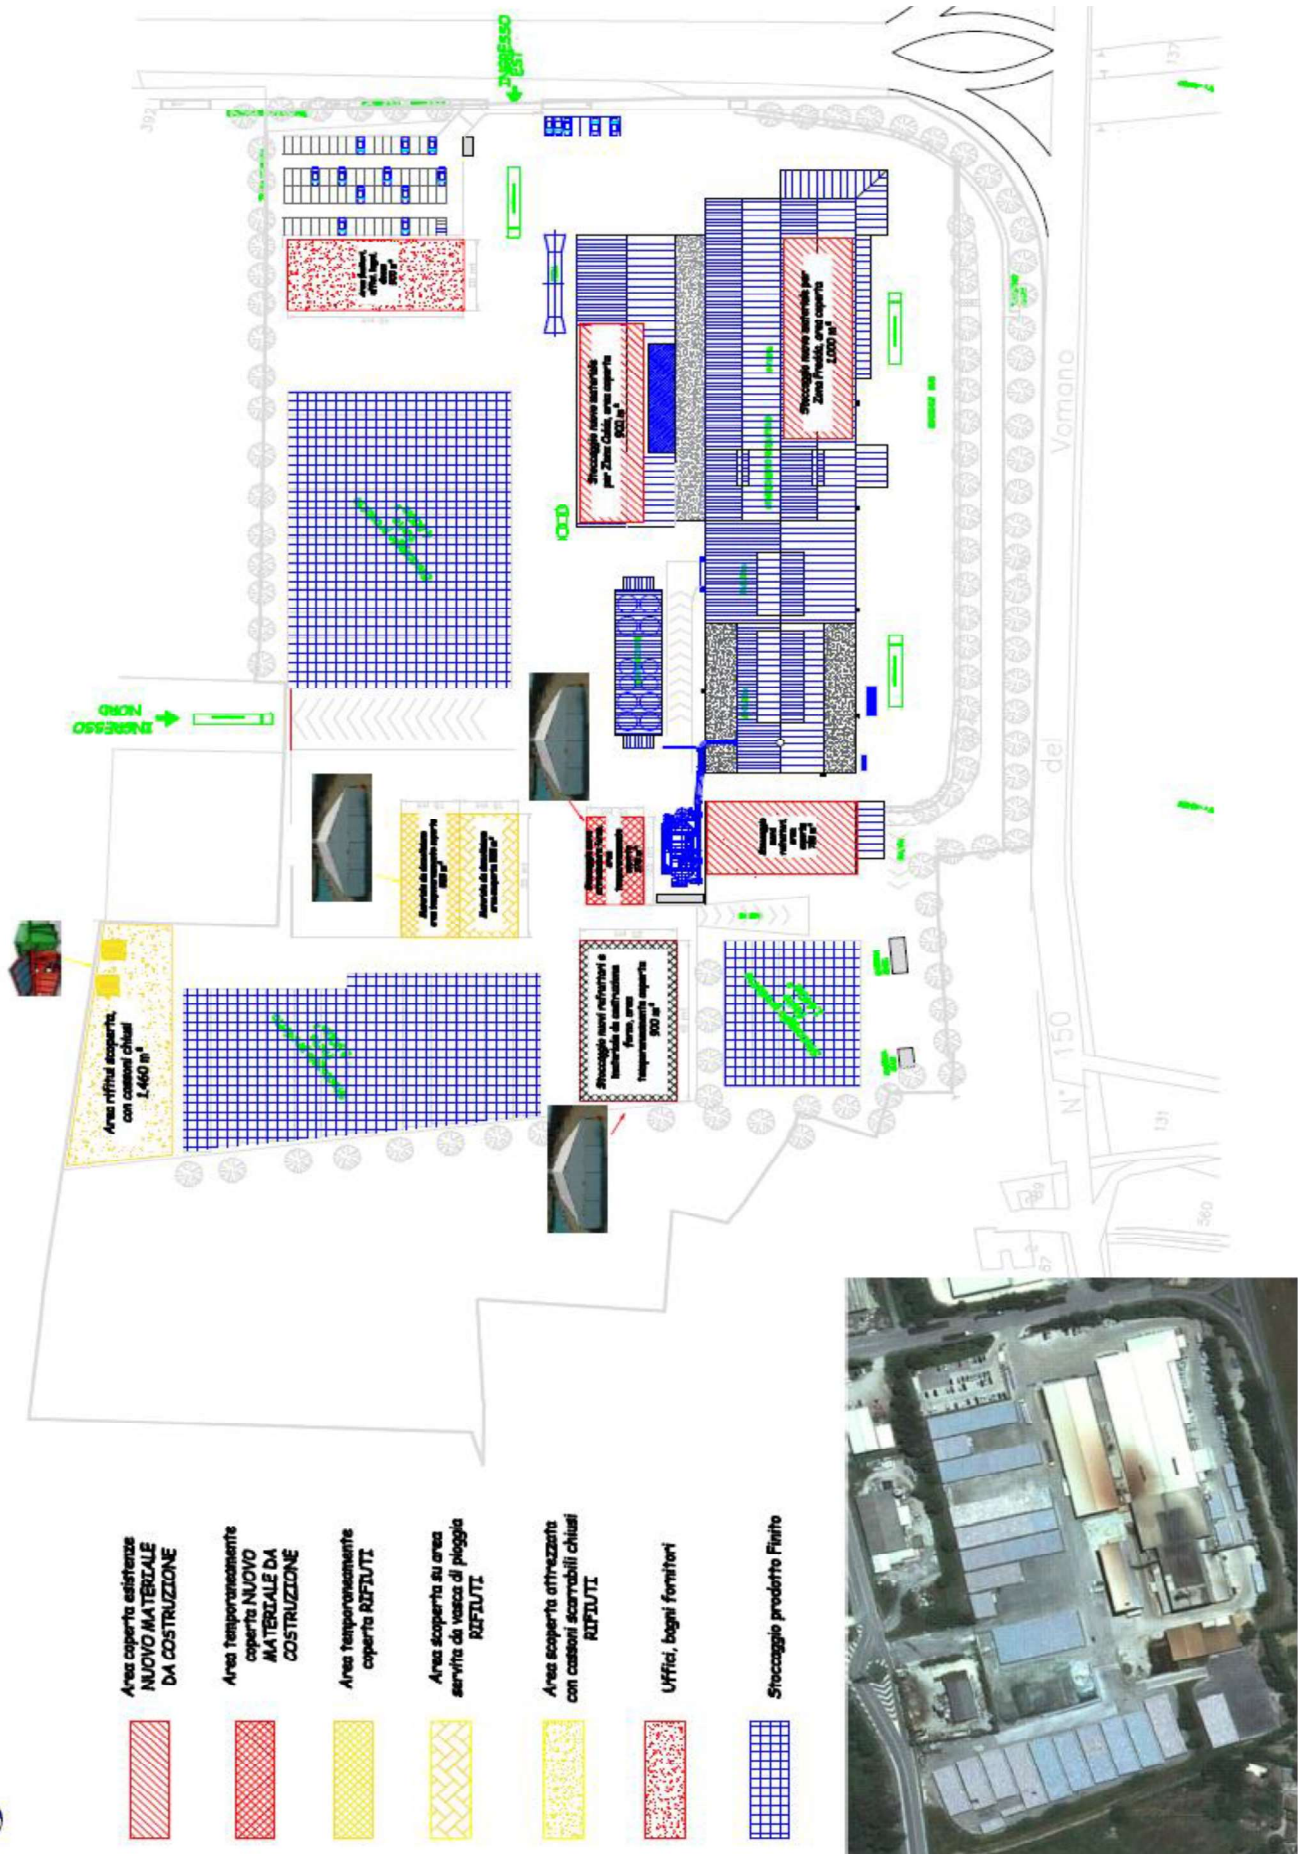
Planimetria depositi esterni durante la fase di cantiere
